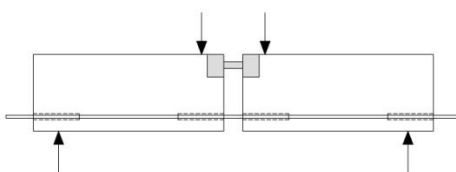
Esquema simplificado de um ensaio de viga adaptado de [28]
